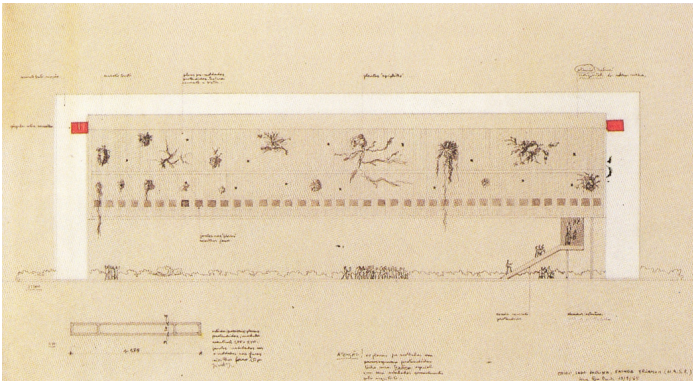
Estudo para a fachada da Avenida Paulista, 1965.
